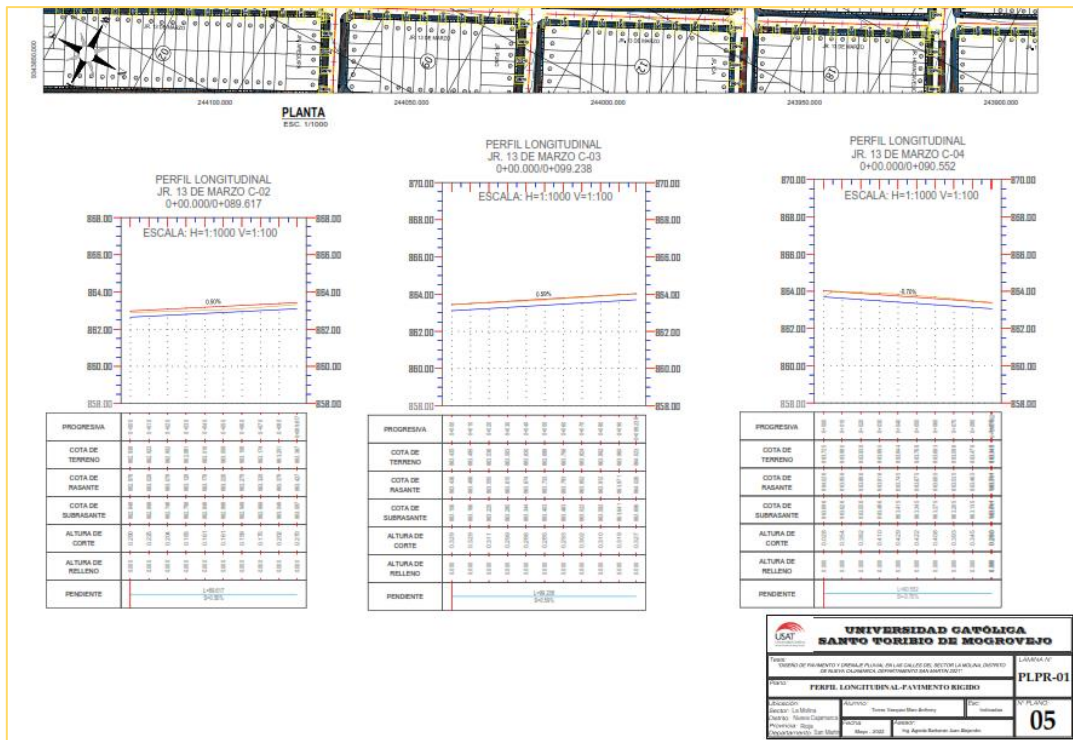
Plano de Perfiles Longitudinales al Pavimento.
